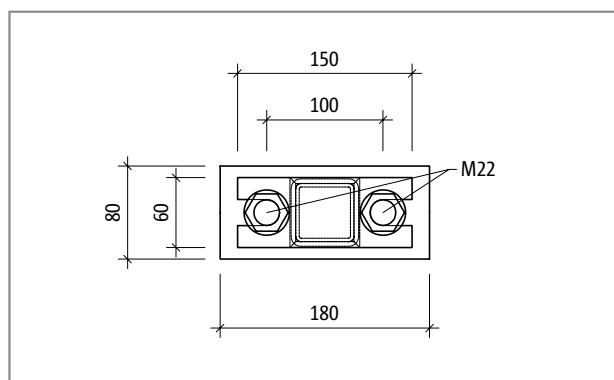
Schöck Isokorb® T tipo S-V-D22: vista dell'elemento
